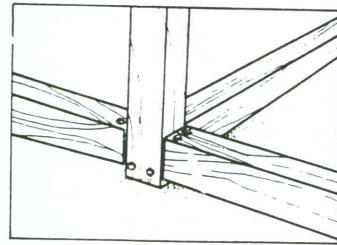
Instalación de refuerzos bajo el nivel del terreno
